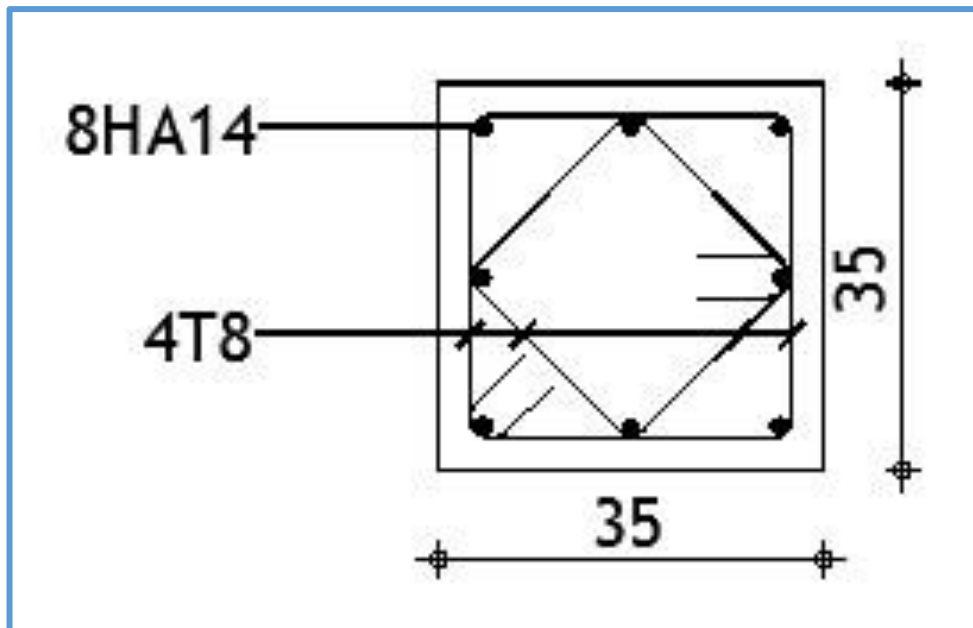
Ferrailage des poteaux carré (35×35)
